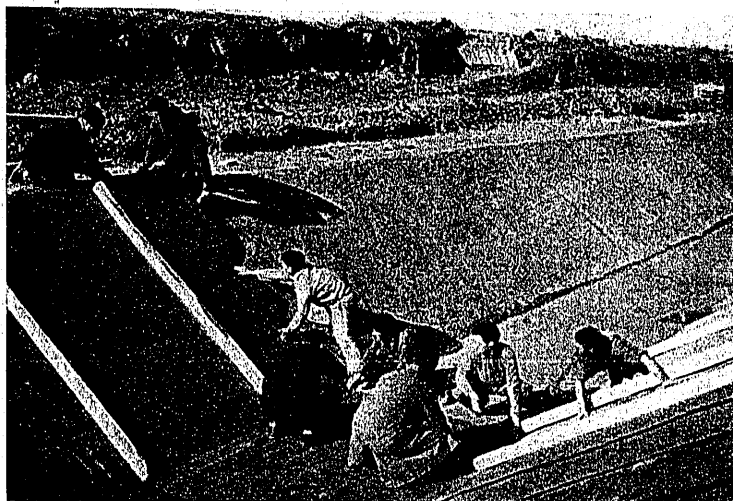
Ejecución de las obras de revestimiento exterior en el tipo C.
